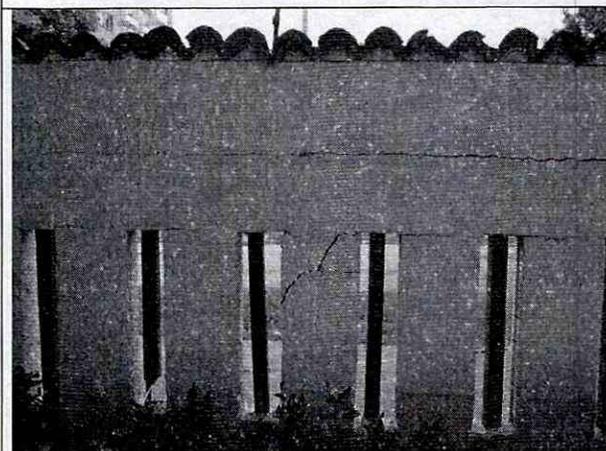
Grietas con separaciones de varios milímetros.
